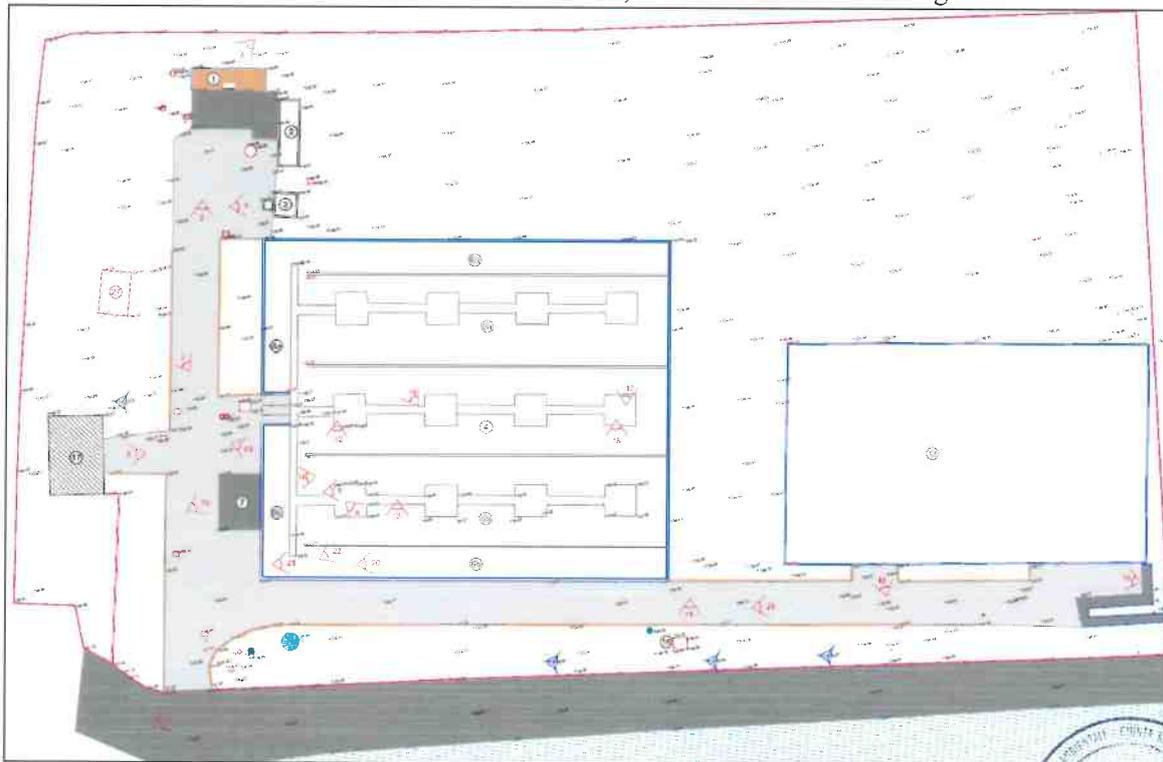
Planimetria stato di fatto (da Tav. B1-05 allegata allo SPA)
